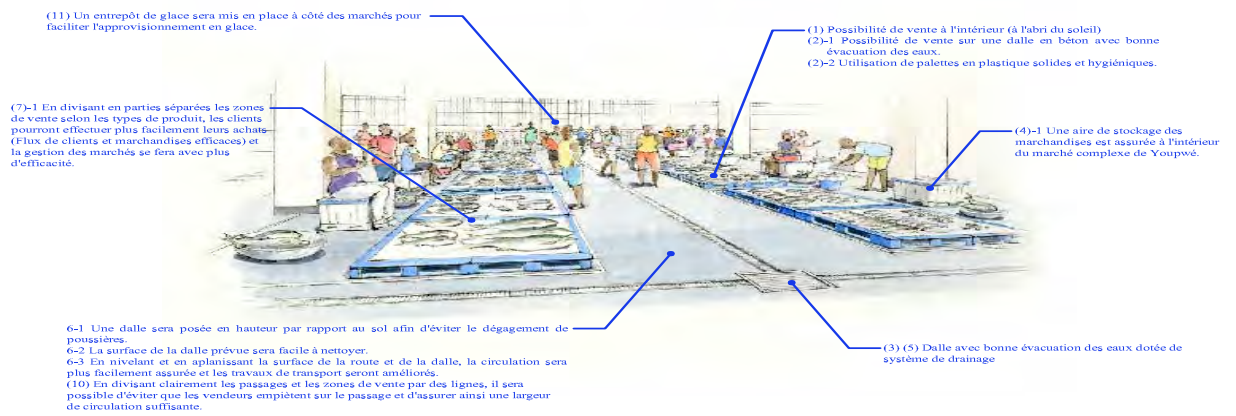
Illustration du plan des installations 1 (marché en gros des poissons frais)
